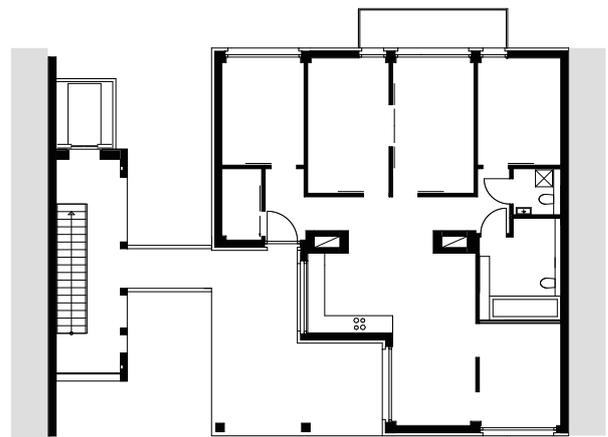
E3 Wohnhaus, 1. Obergeschoss
